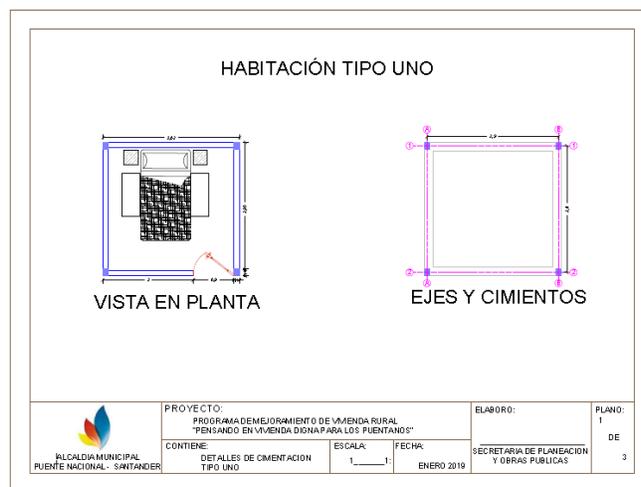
Vista en planta, ejes y cimentaciones de la habitación.
